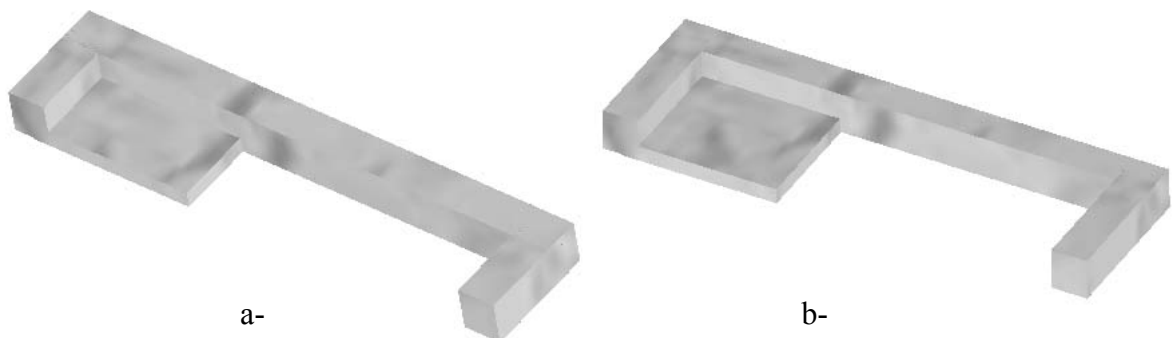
Dalles pleines sur 2 appuis continus :
